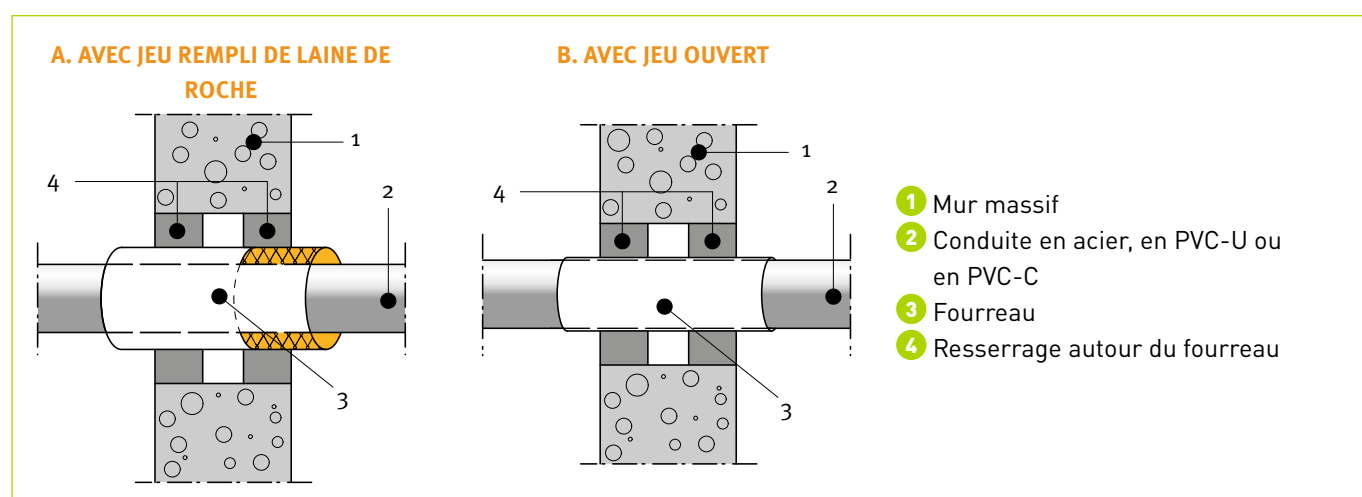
Traversée d'un mur massif résistant au feu par une conduite en acier ou en PVC : obturation avec un fourreau.
